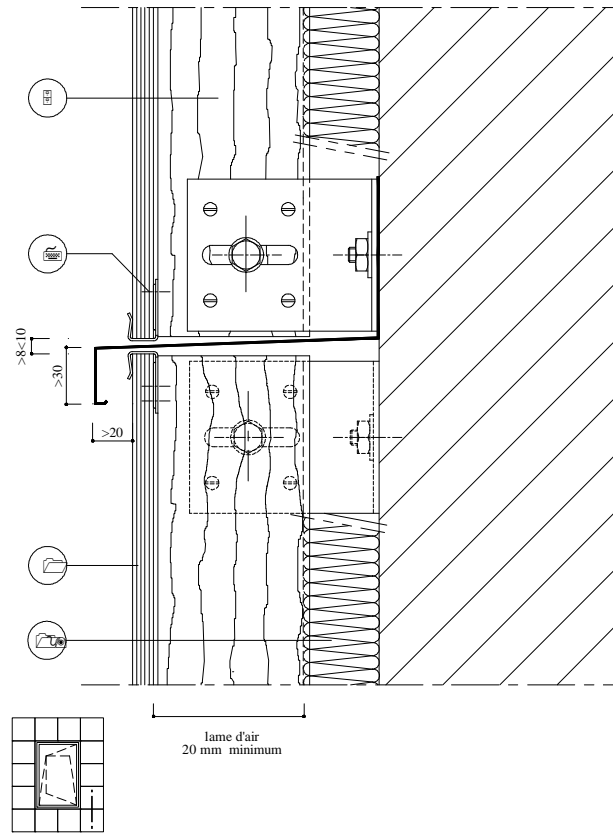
Fractionnement de la lame d'air – Coupe verticale
